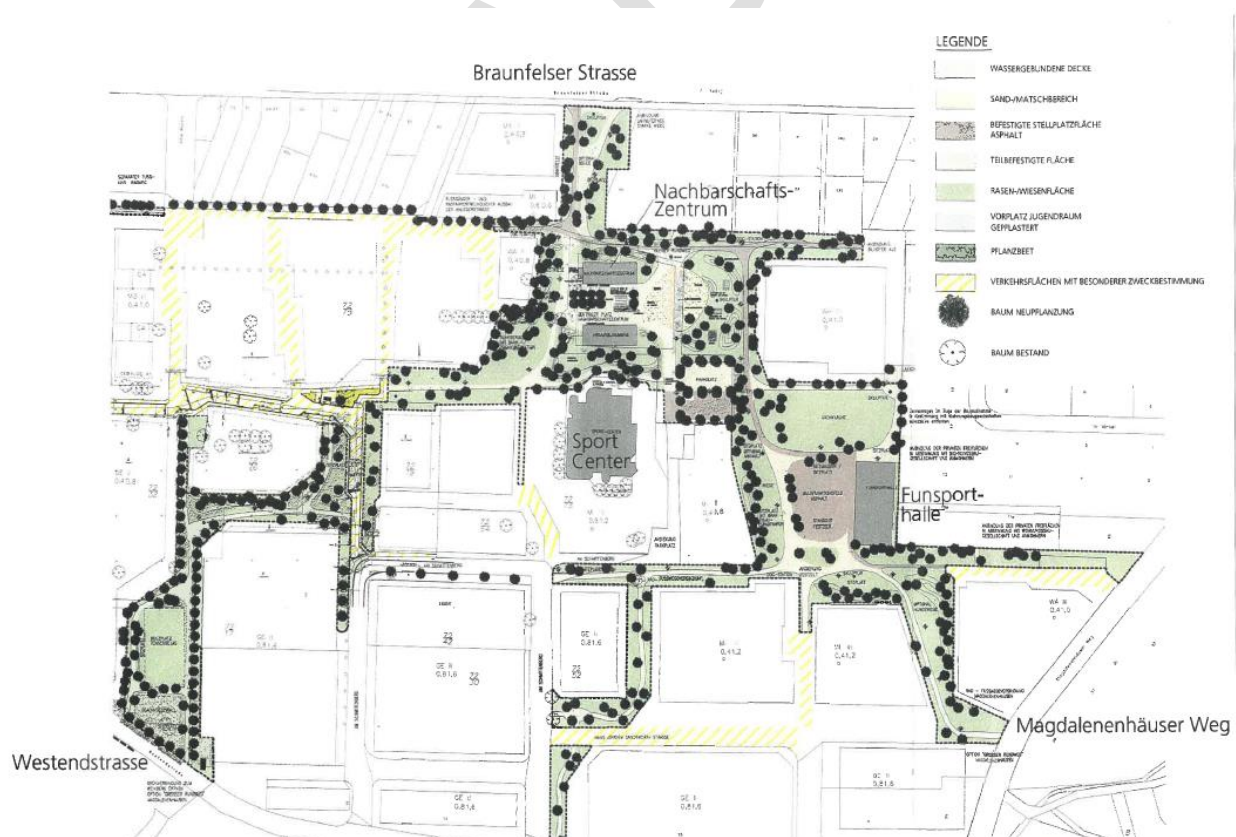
Planzeichnung Zentrales Grün Silhöfer Aue aus dem Masterplan (Sommerlad, Haase, Kuhli Landschaftsarchitekten 2004)
